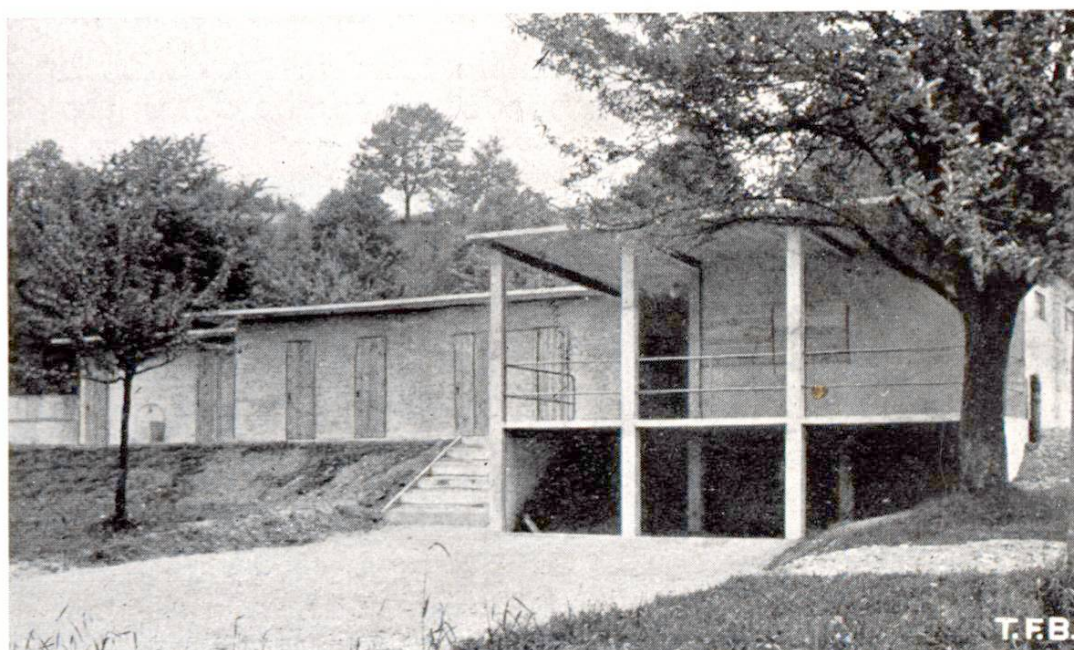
Les travaux de superstructure de la plage de Tennwil (Hallwilersee) ciment-métal déployé et béton armé.
